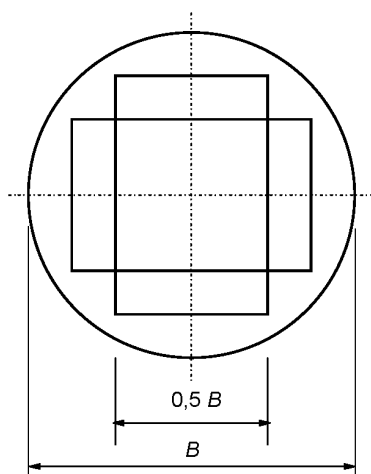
Armadura ortogonal en una zapata circular sobre suelo
